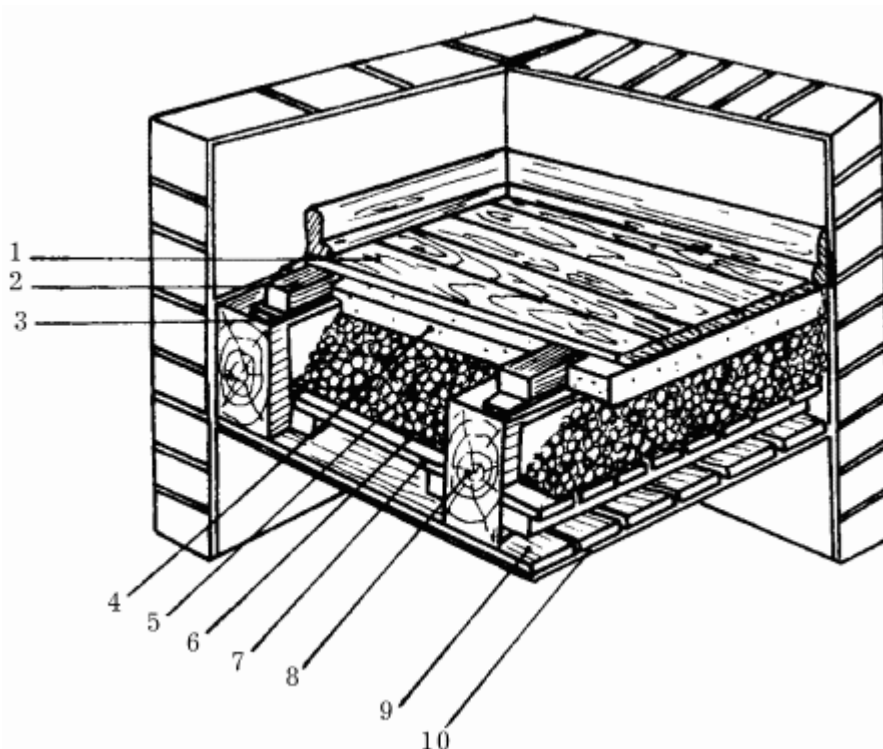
Деревянное балочное перекрытие: 1 – чистовое покрытие; 2 – лаги; 3 – звукоизоляционный слой; 4 – засыпка; 5 – старая засыпка; 6 – картон; 7 – черный пол; 8 – балка перекрытия; 9 – обрешетка; 10 – чистая штукатурка.
